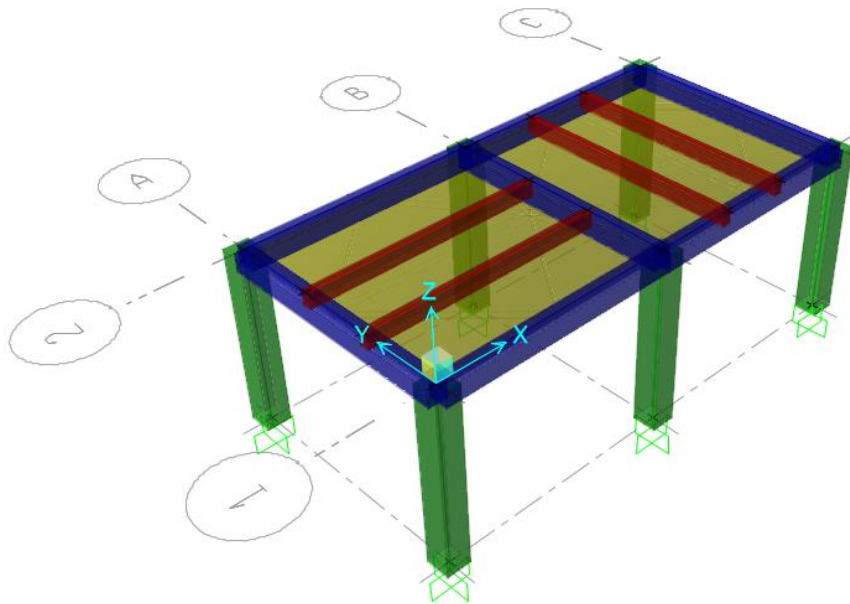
Vista isométrica de losa metaldeck en SAFE
